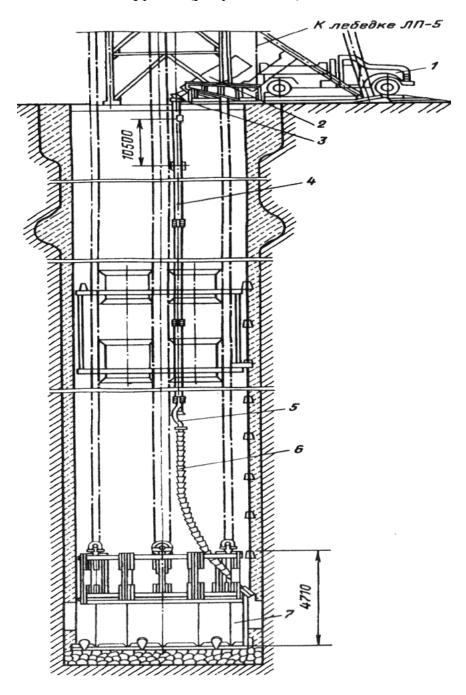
Схема размещения оборудования для возведения монолитной бетонной крепи
